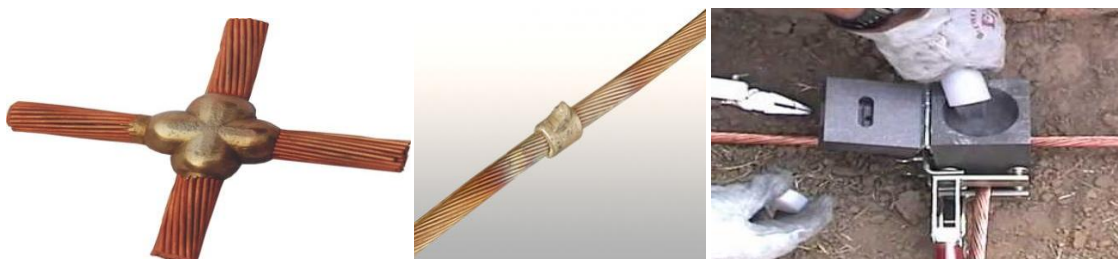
Exemplos de soldadura aluminotérmica (esquerda e centro) e preparação da soldadura (direita)
